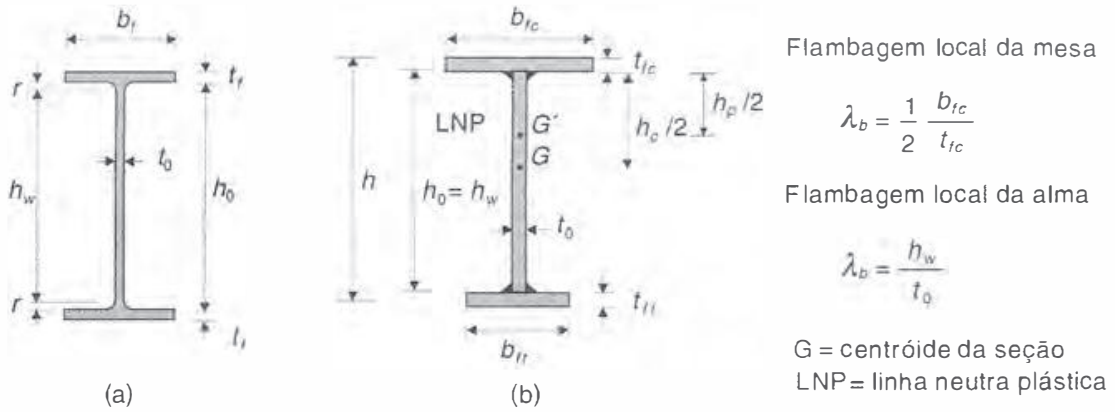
Notações utilizadas para efeito de flambagem local sobre a resistência à flexão de vigas I ou H com um ou dois eixos de simetria. (a) perfil laminado; (b) perfil soldado.
